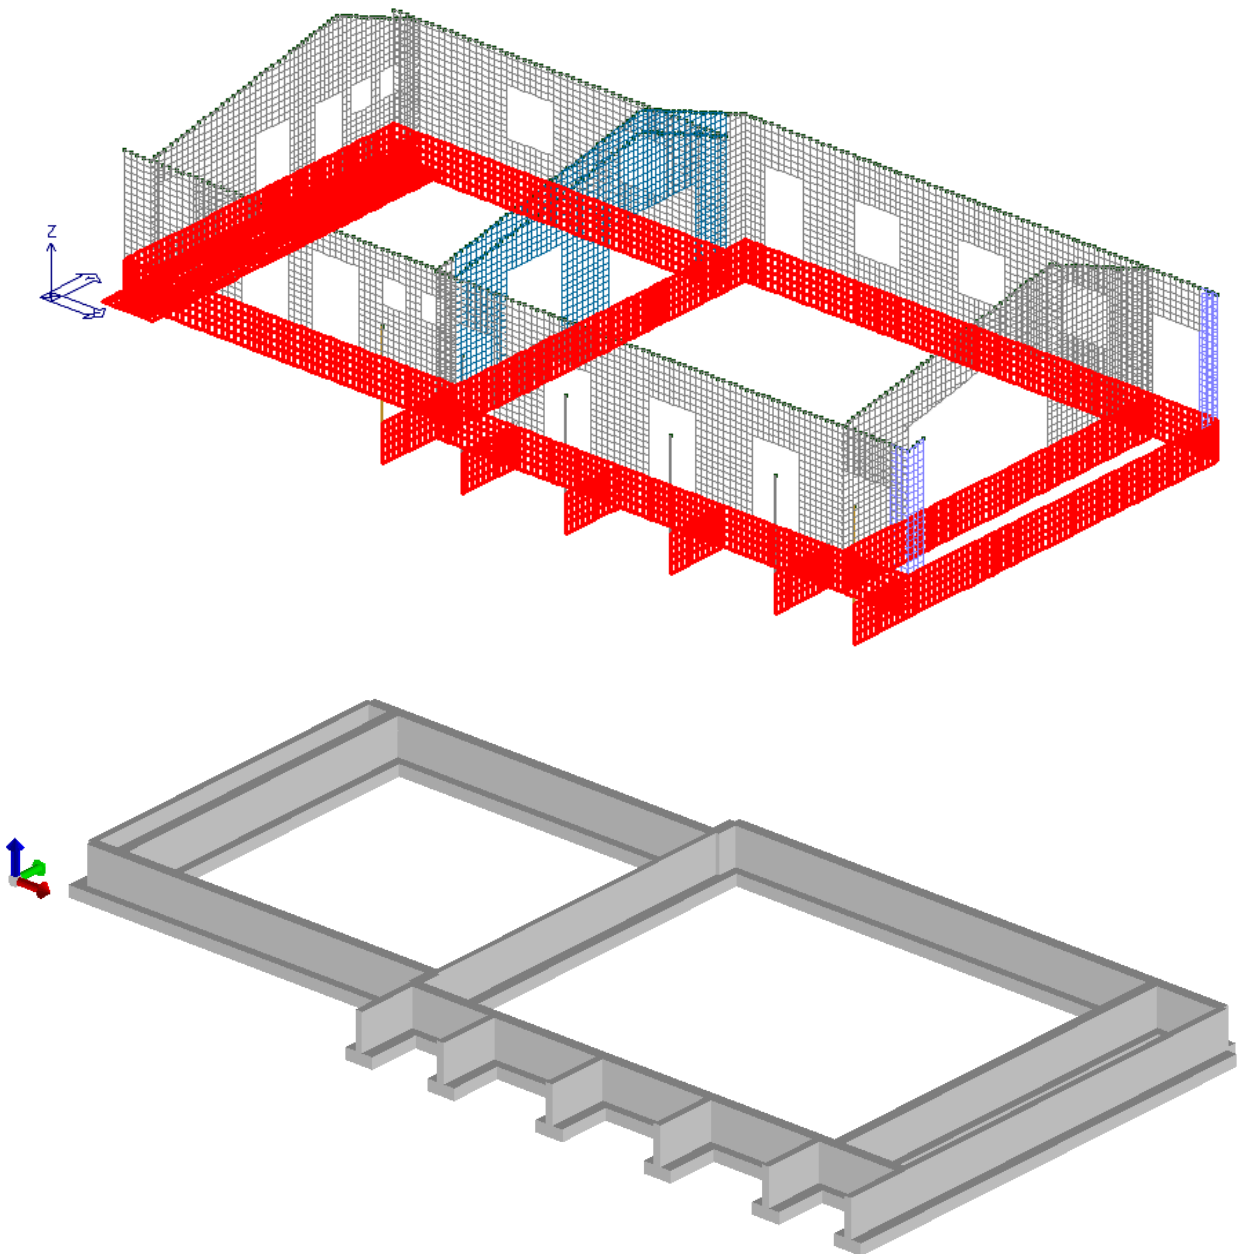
Setti di fondazione oggetto di verifica – Vista Unifilare (Completa) – Vista solida (fondazioni).
